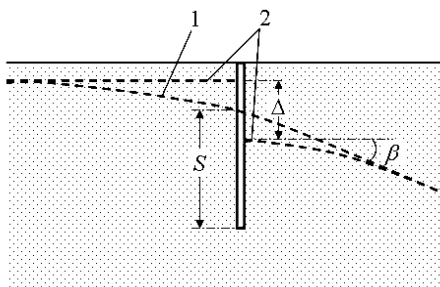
Схема к расчету подпора шпунтом. 1 и 2 – положение грунтовых вод до и после установки шпунта.
